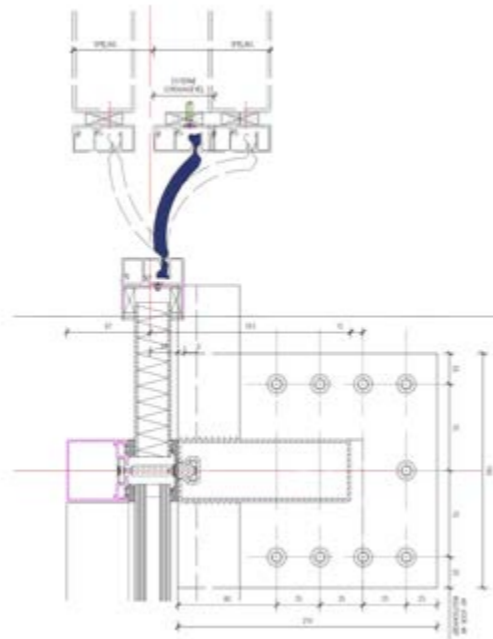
Détail du raccord flexible. (Source : Bureau Bouwtechniek)
